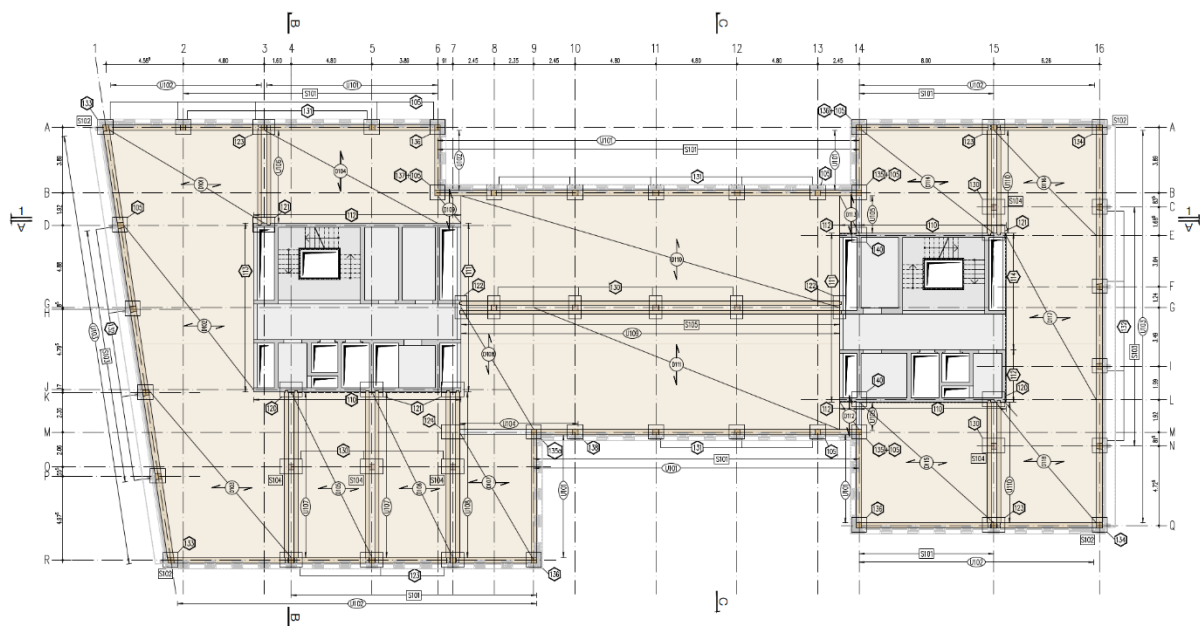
Grundriss Regelgeschoss – Positions- und Detailübersichtsplan
